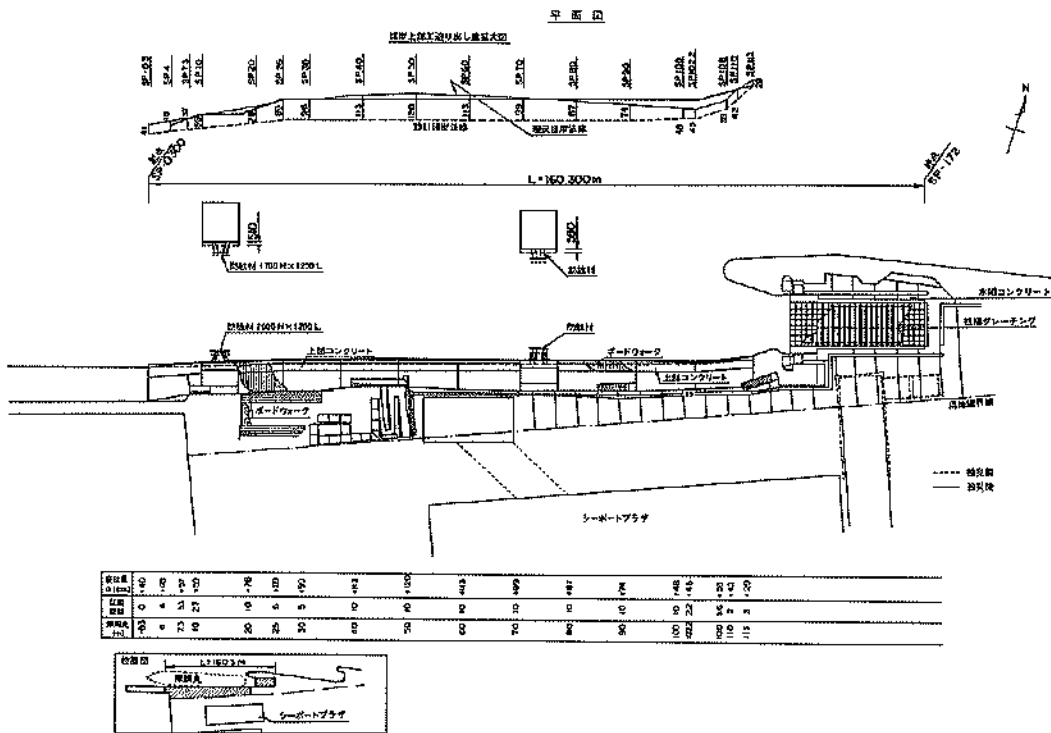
(a) 若松埠頭護岸被災平面図 (函館港)
